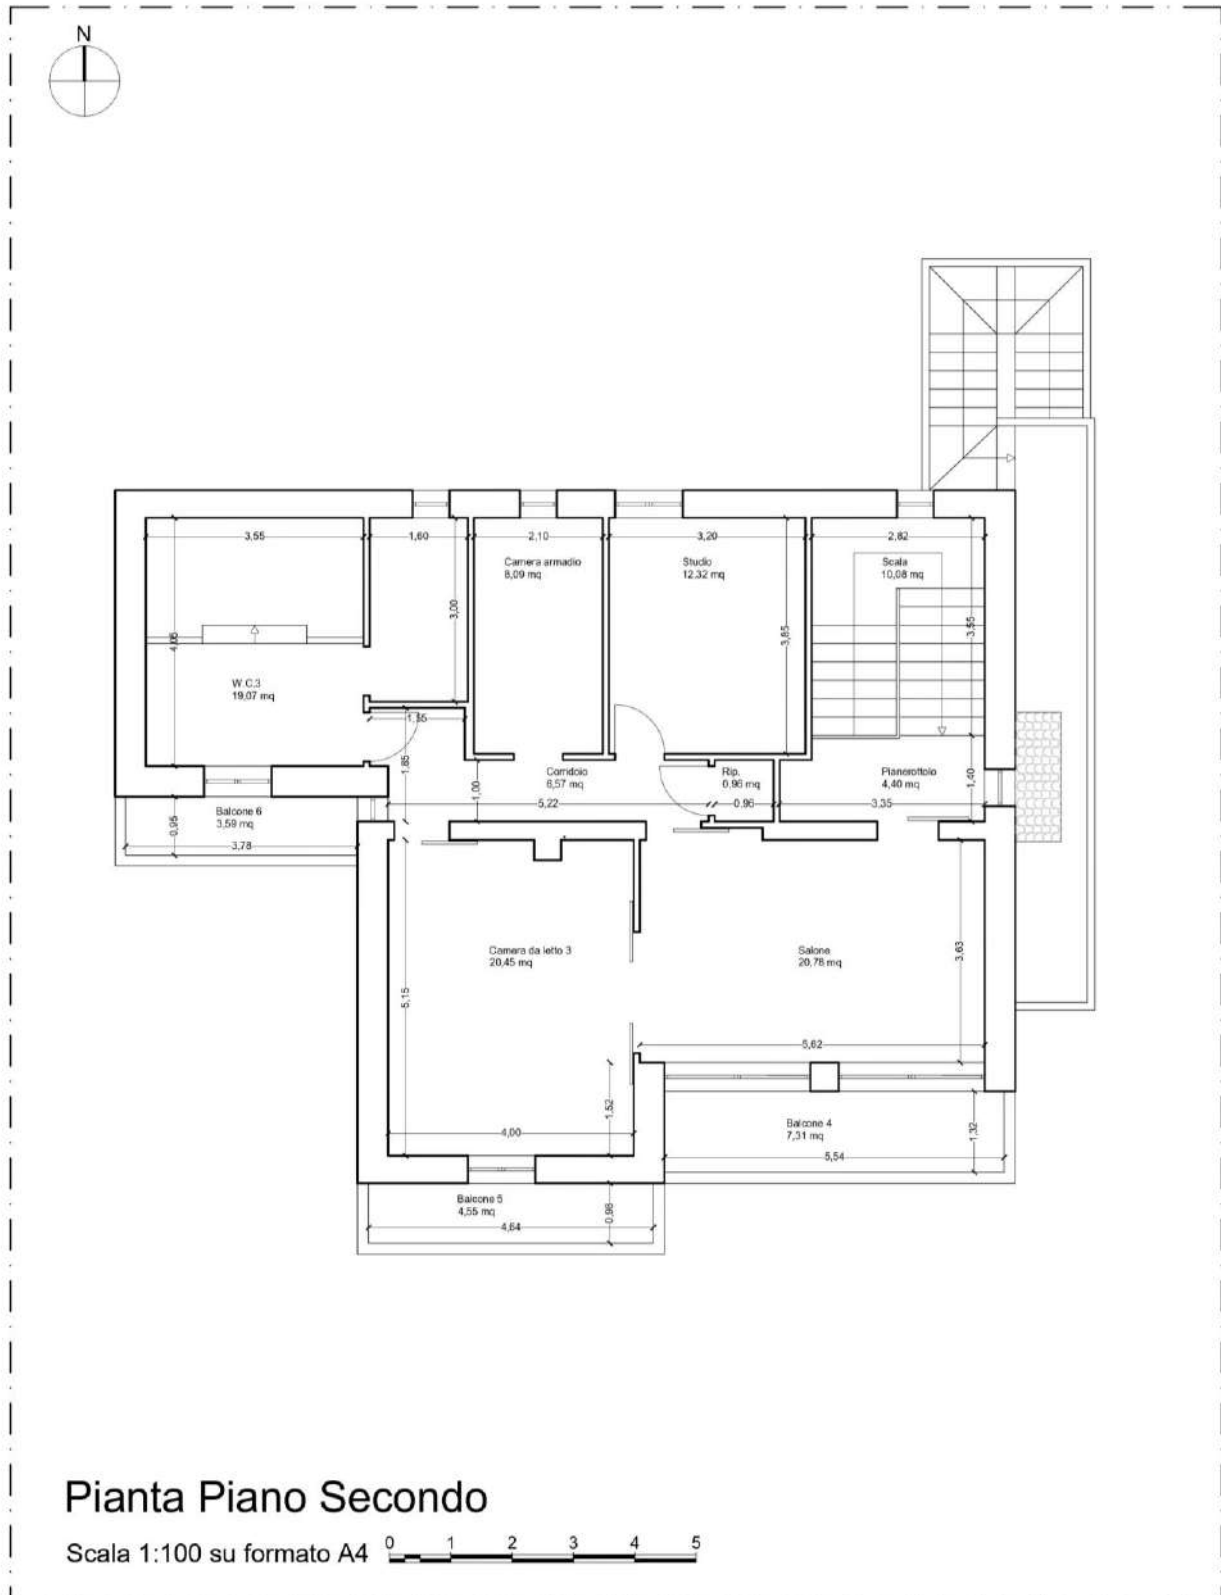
Planimetria dello stato di fatto – Pianta Piano Secondo
